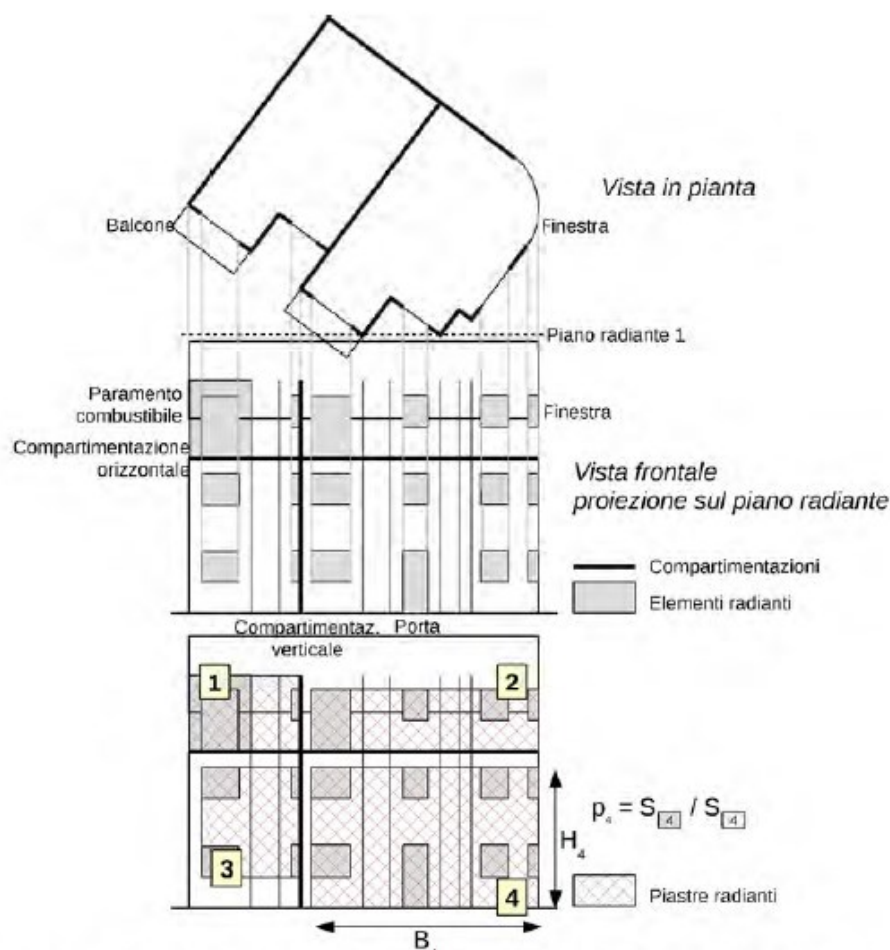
Determinazione delle piastre radianti, vista in pianta e frontale
